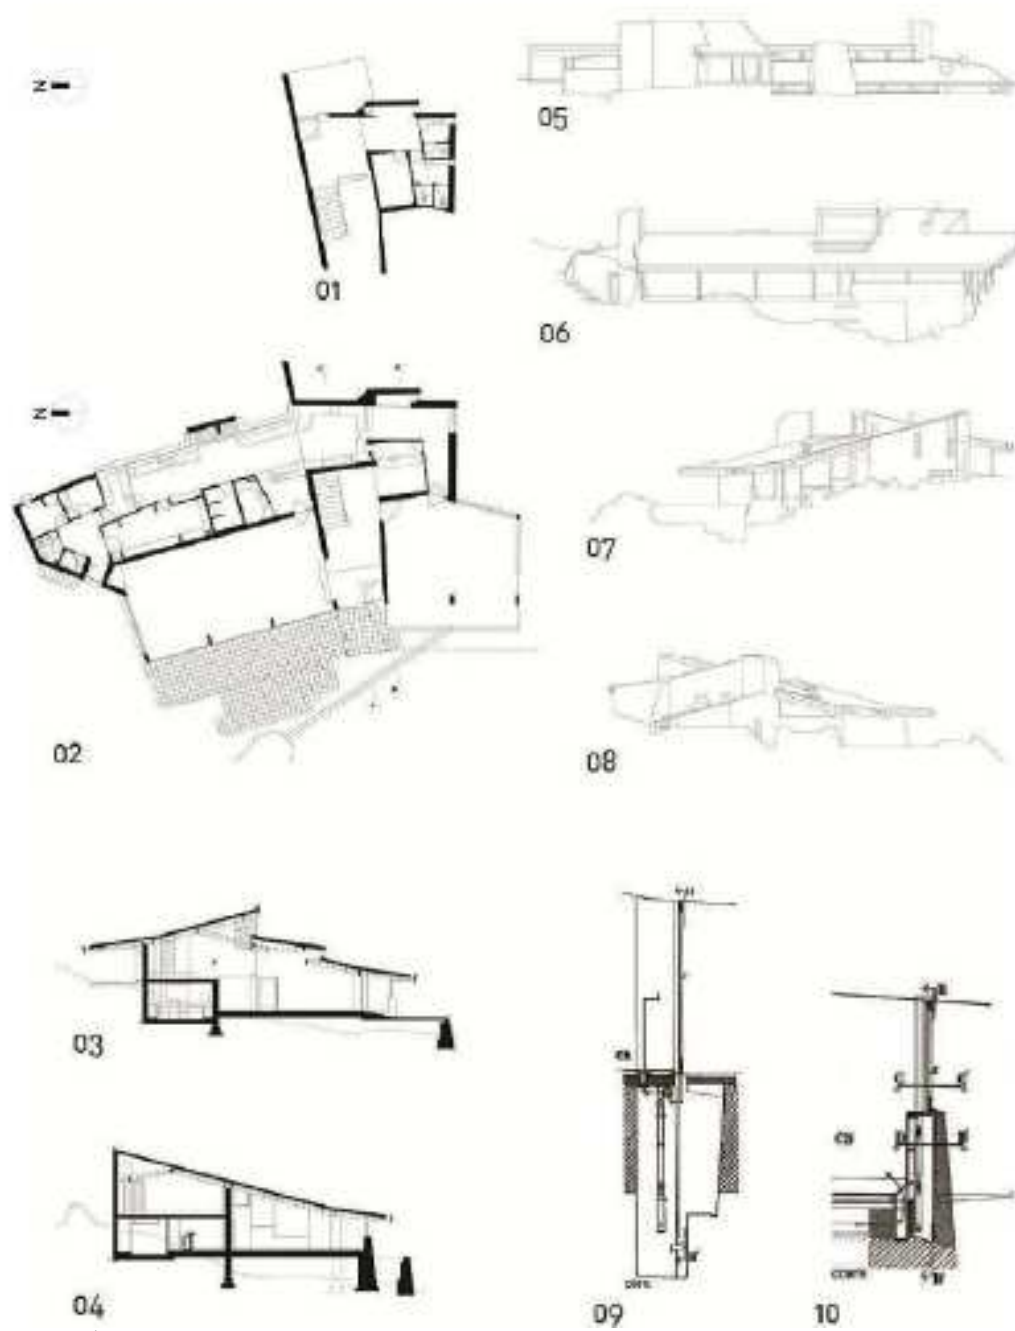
Álvaro Siza Vieira, Restaurante da Boa Nova (1958-63)
